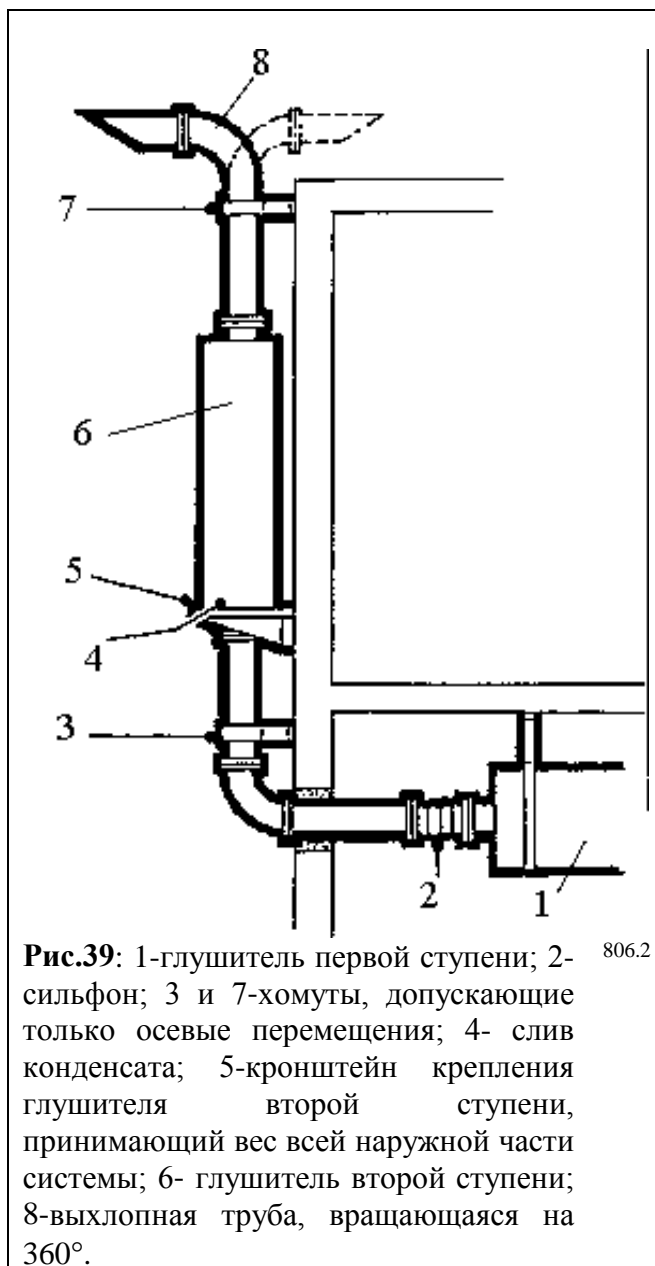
1-глушитель первой ступени; 2-сильфон; 3 и 7-хомуты, допускающие только осевые перемещения; 4- слив конденсата; 5-кронштейн крепления глушителя второй ступени, принимающий вес всей наружной части системы; 6- глушитель второй ступени; 8-выхлопная труба, вращающаяся на 360°.
